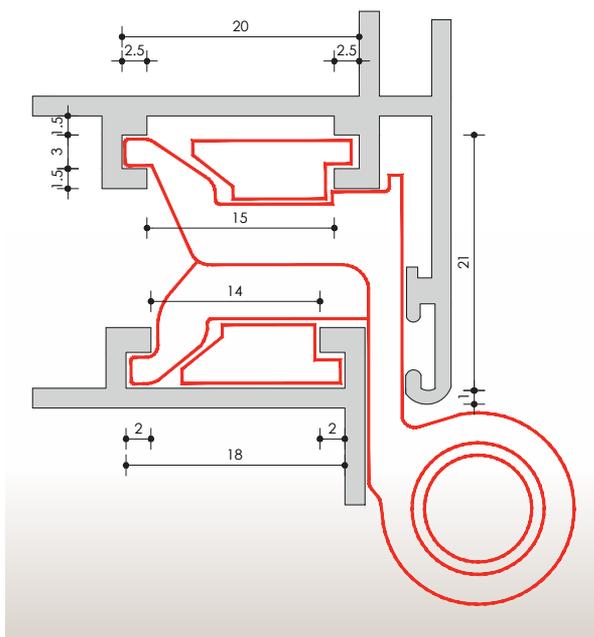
Detalle de perfil de aluminio con "cámara europea".
